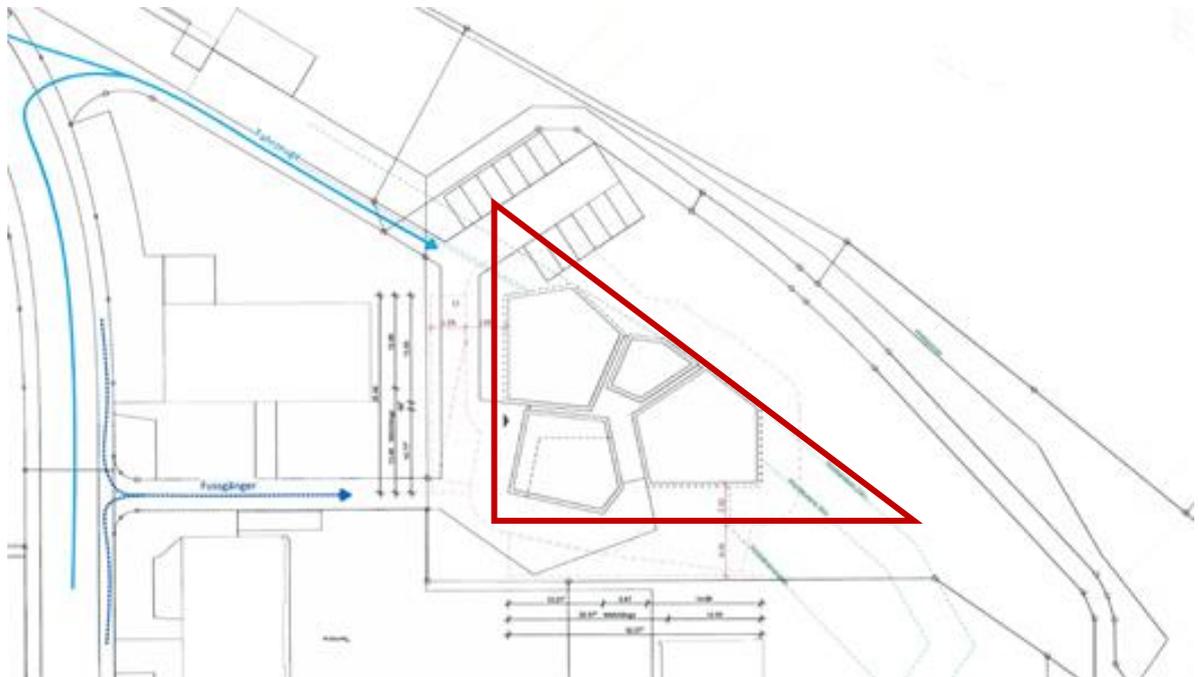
Mögliche Lösung mit dreigeschossigen Volumen (freie Raumformen) auf der verbleibenden Dreiecksfläche
